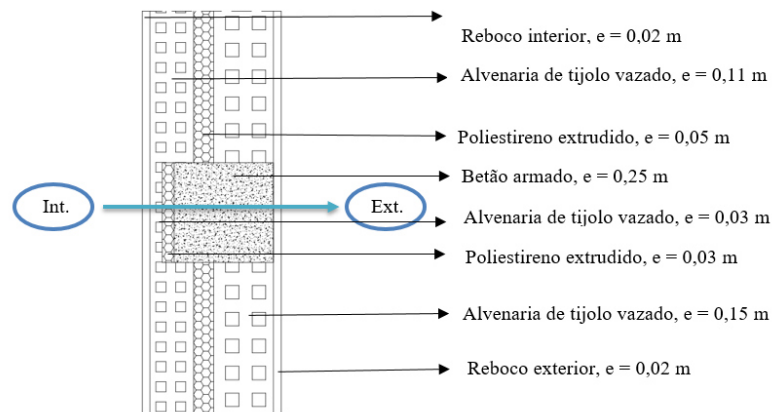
Pormenor construtivo das paredes exteriores na zona corrente
